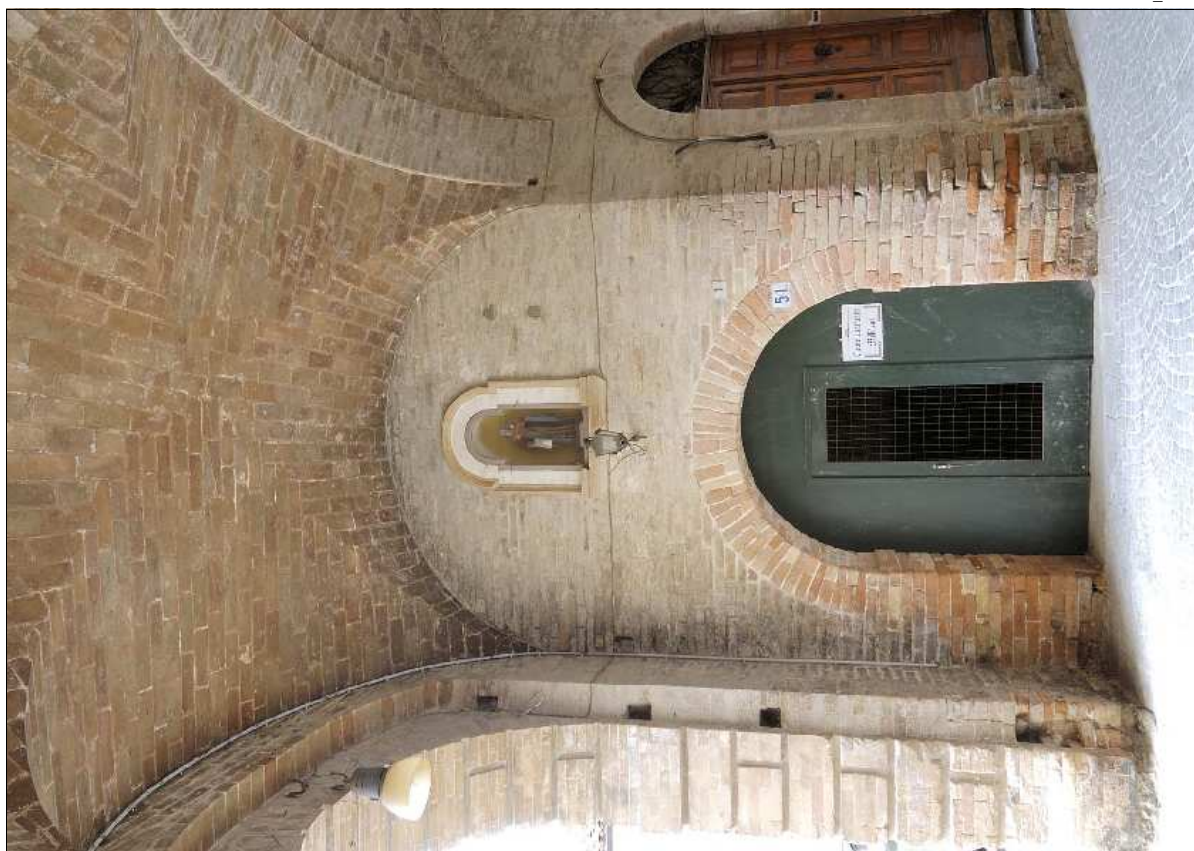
Lato nord accesso antichi camminamenti militari
